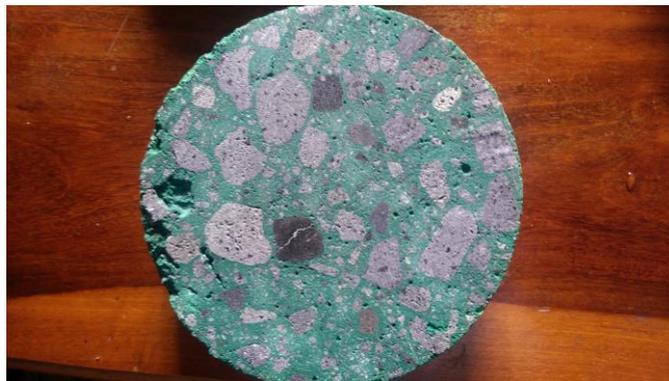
Hormigón fluorescente con 60g de pigmento
